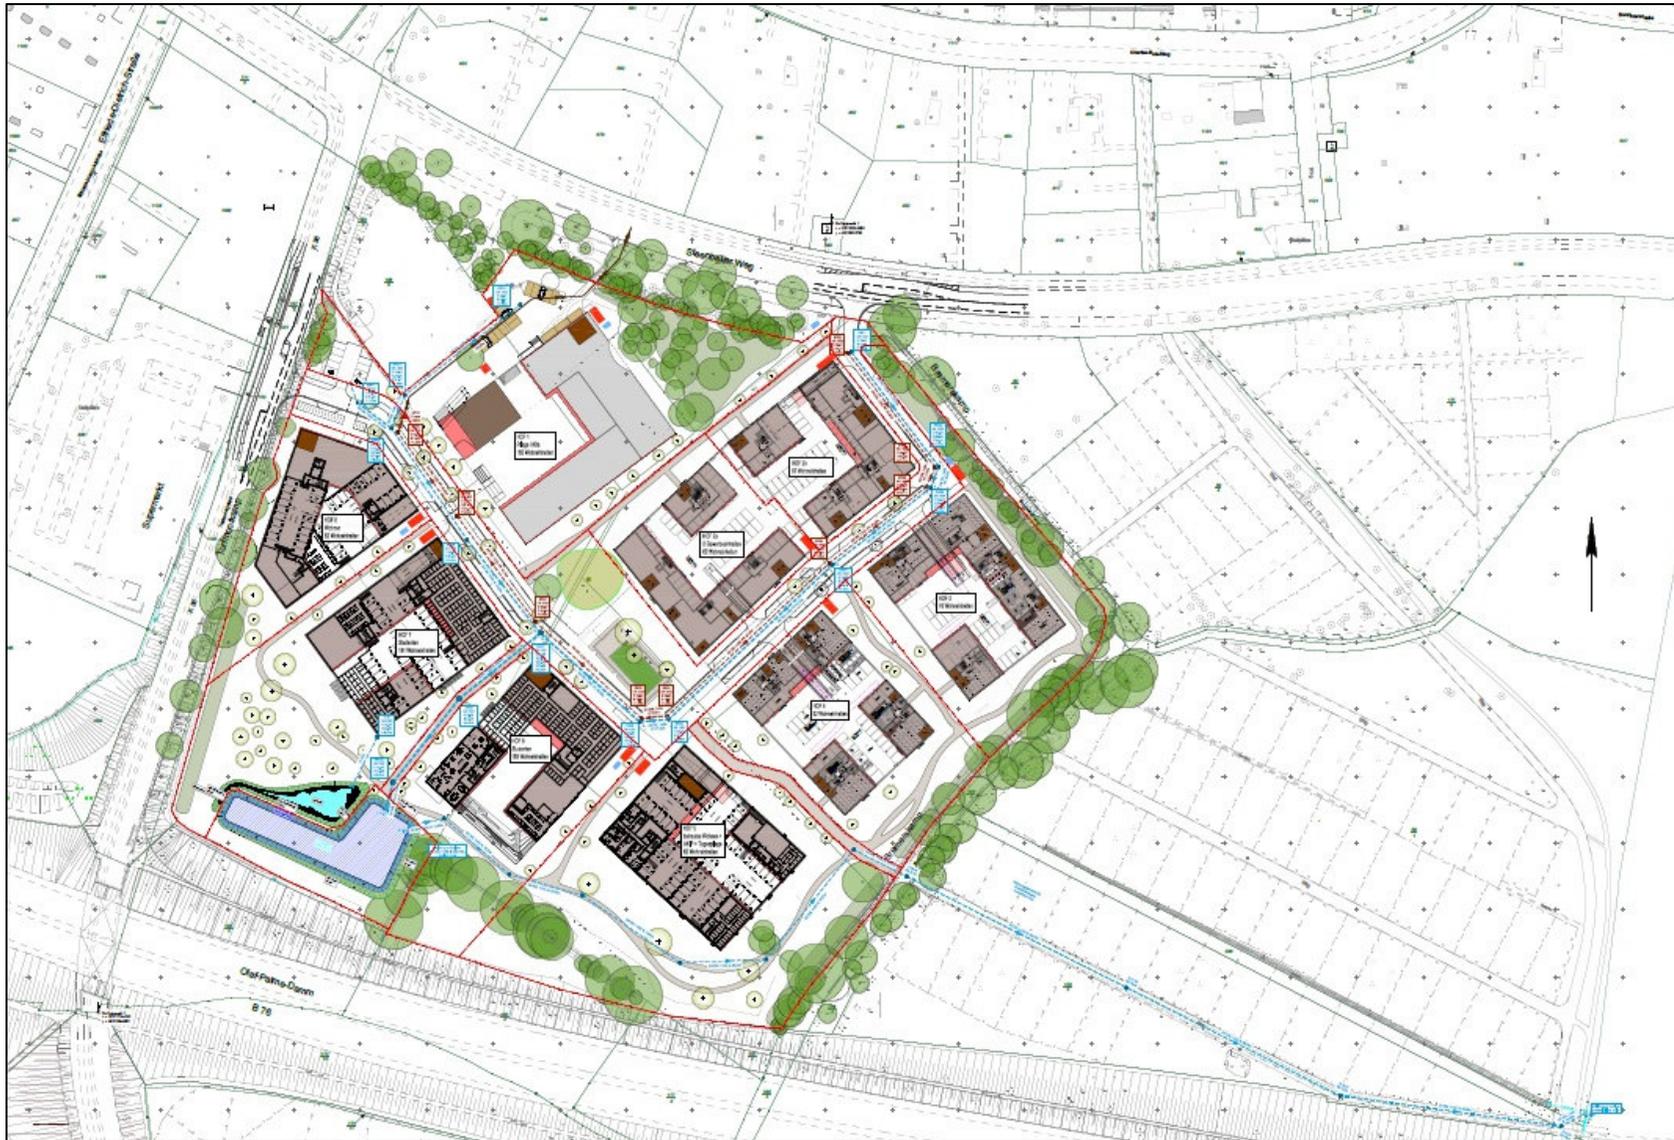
Entwässerungslageplan mit Verlauf der geplanten Rohrleitung aus dem Regenwasserrückhaltebecken bis in den Einspeisepunkt im Osten
